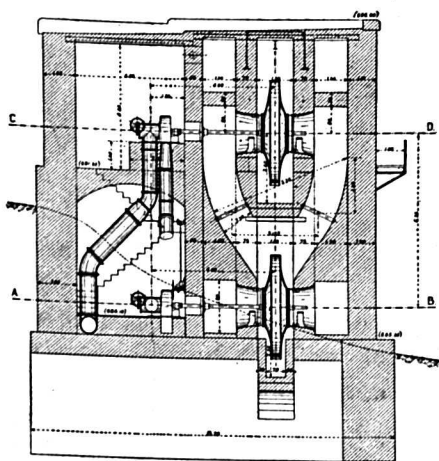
Coupe verticale par F E, montrant la disposition de l'accouplement en série.
